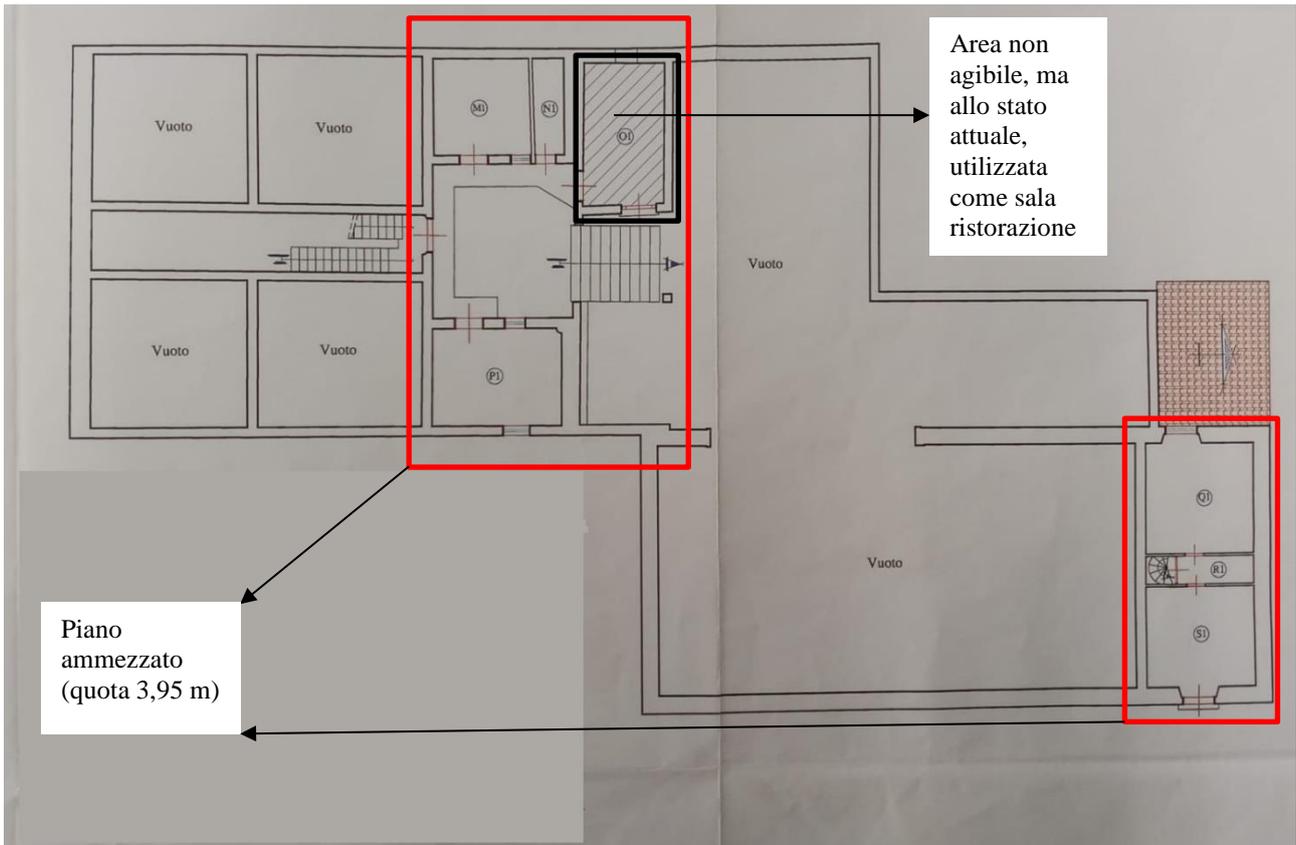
Planimetria piano ammezzato stato di fatto soggetto a SCA
